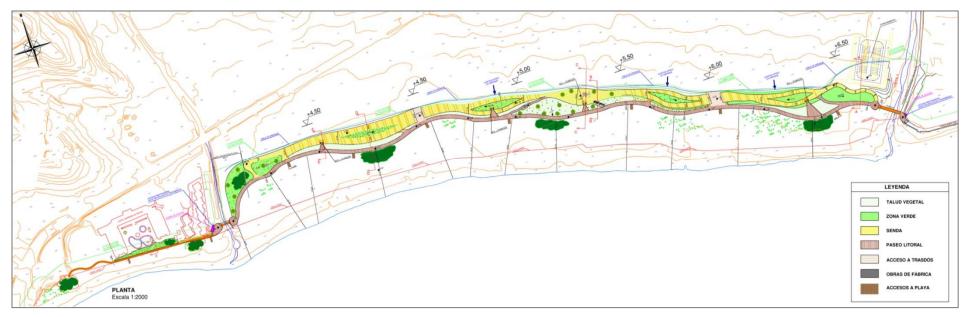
Planta General del Paseo Marítimo de El Playazo proyectado en la Alternativa 3.
